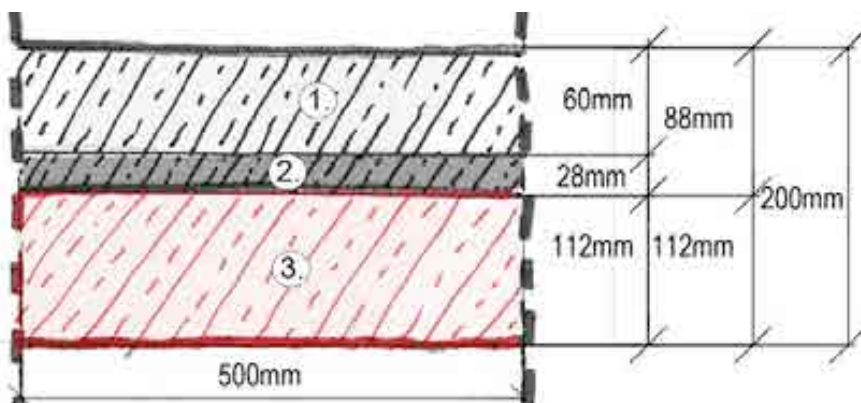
Durchschnittliche Betonmenge, = 88mm Beton Bestand und 112mm Beton Neu,
